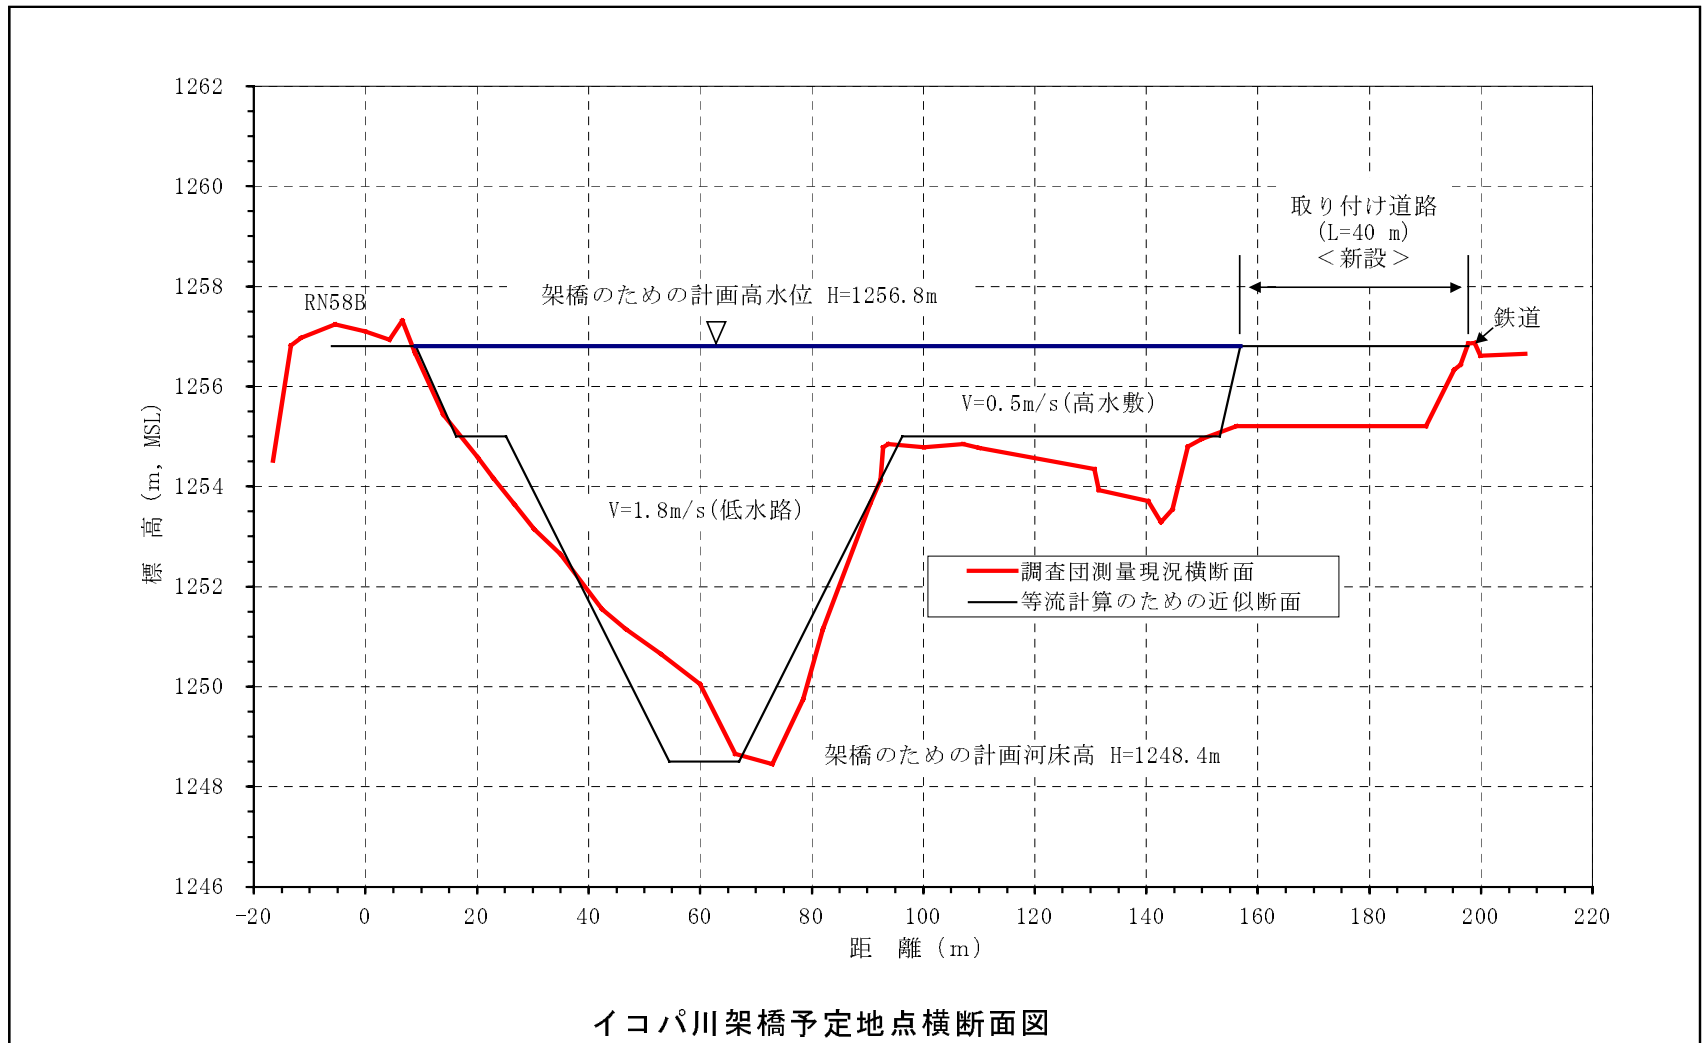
第 2 号橋梁架橋予定地点 (イコパ川) 横断面図
